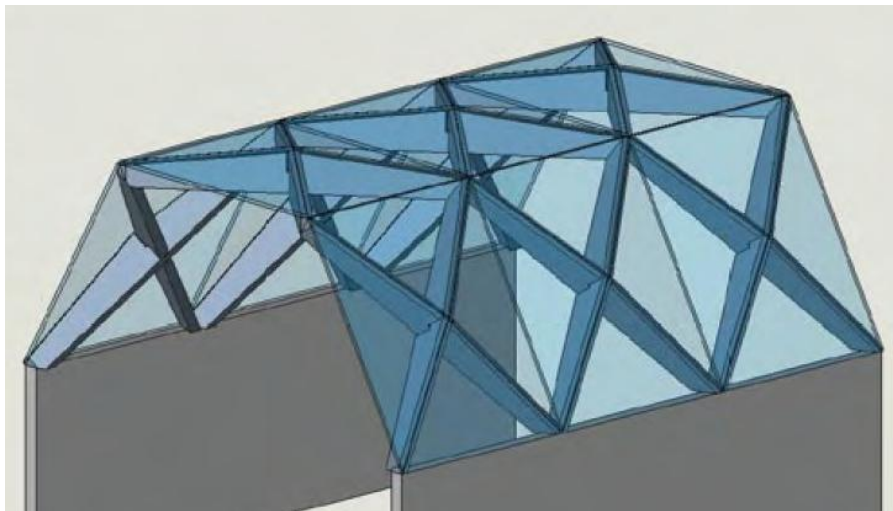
Mur cortina aplicat a un sistema de coberta (Dale, et al., 2008)
